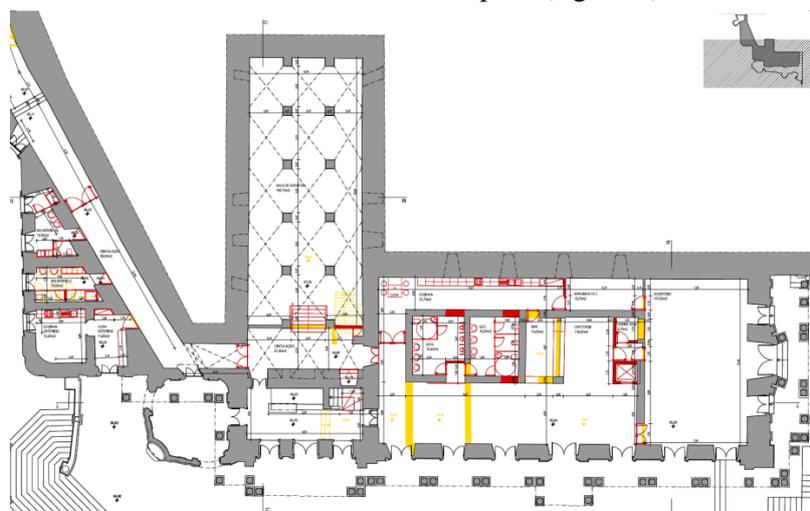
Planta de amarelos e vermelhos do piso térreo do Pavilhão Robillion (fonte: PSML)
